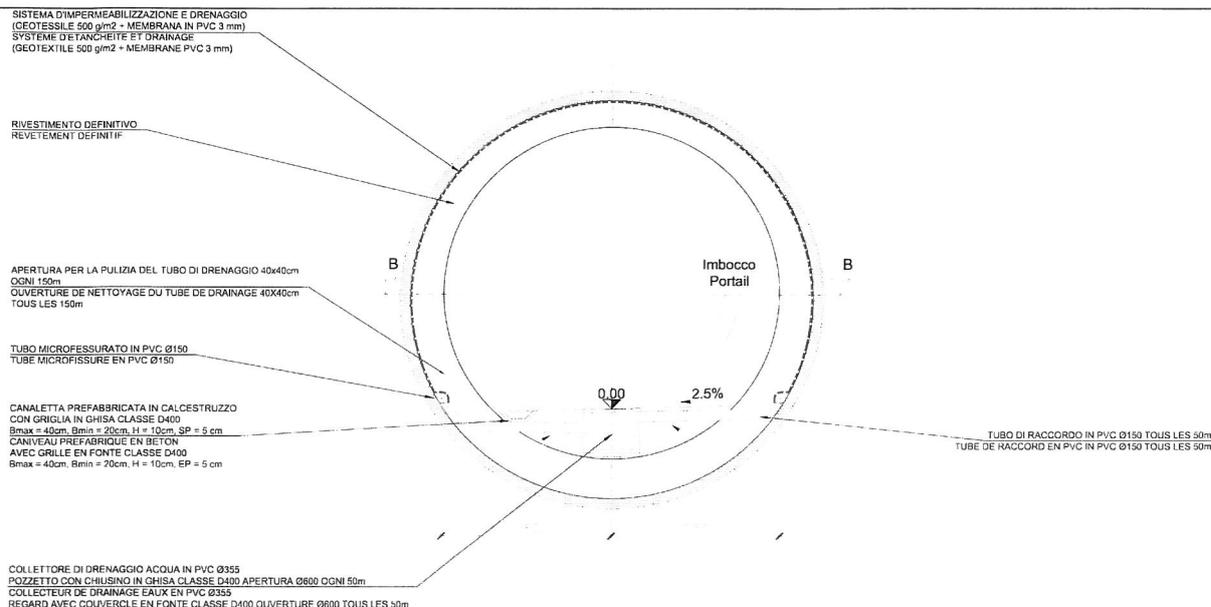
Sistema di drenaggio sulla sezione tipo corrente
